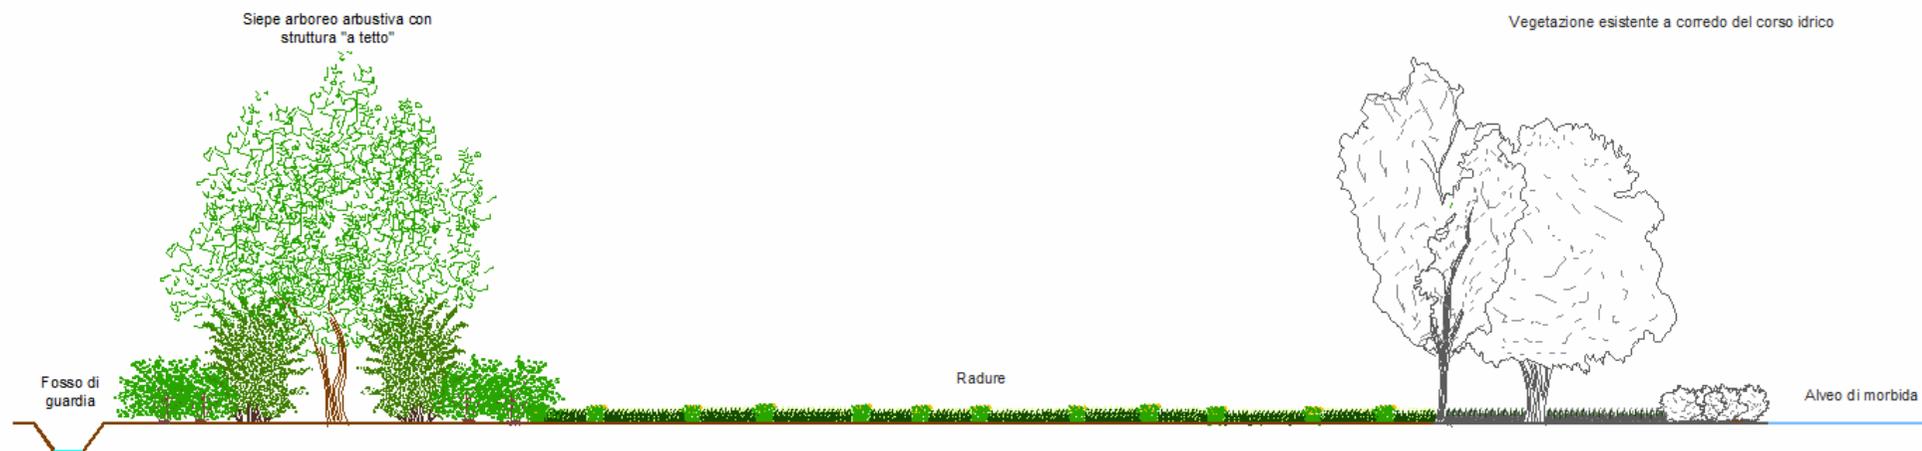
Sezione tipologica della realizzazione delle aree incolte con siepe a tetto a protezione dalle attività agricole.
